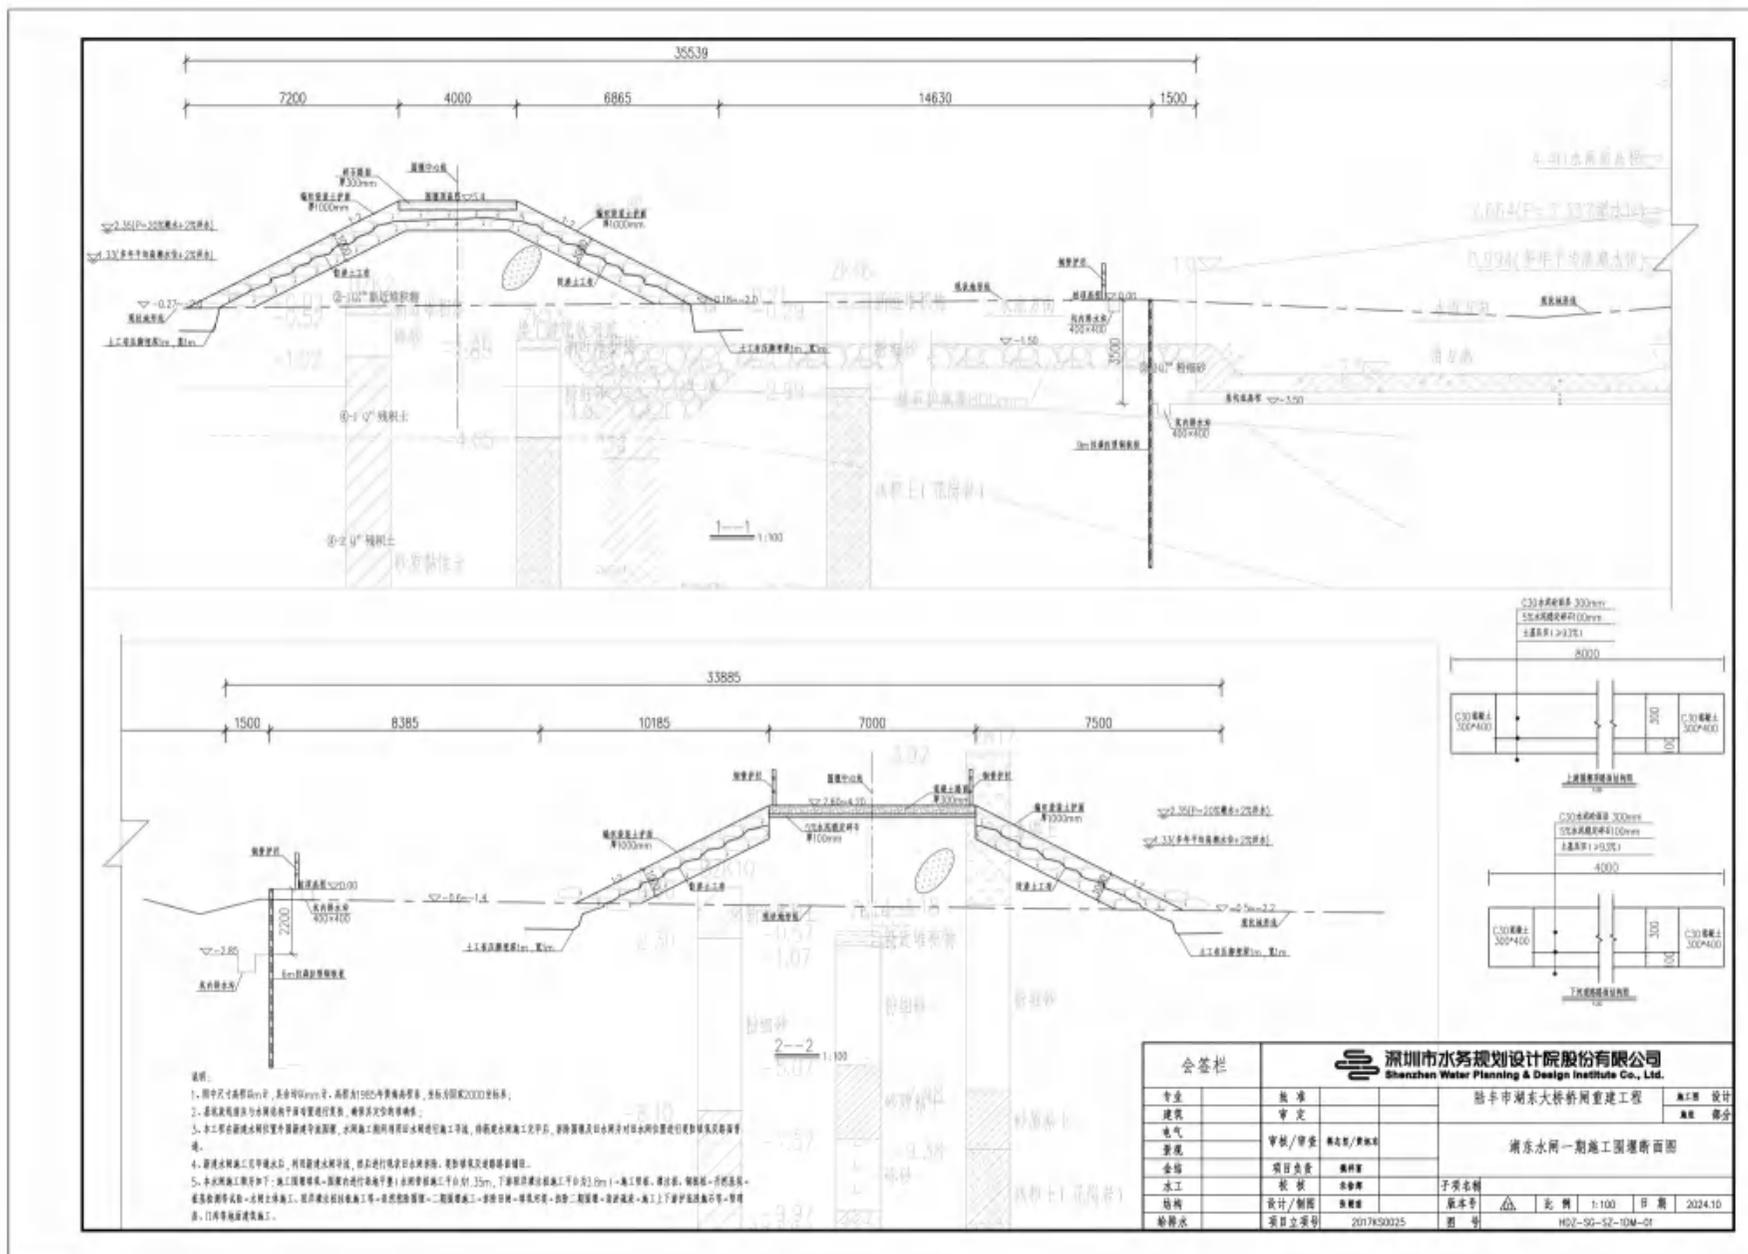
湖东桥闸一期施工围堰断面图
